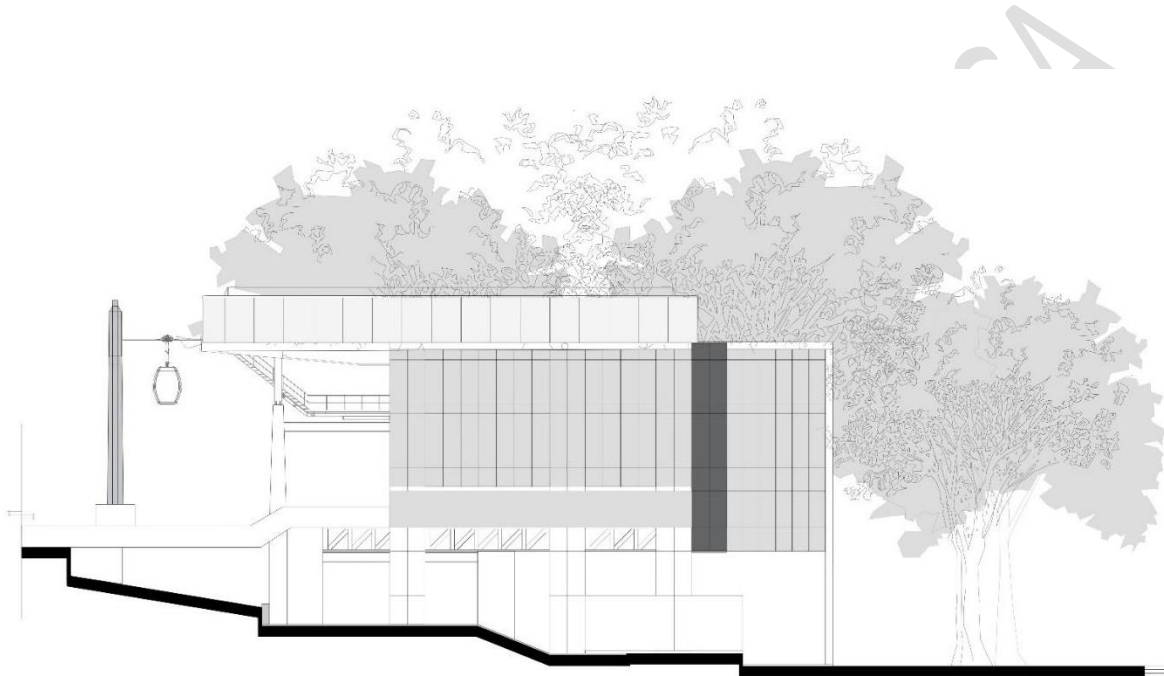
Fachada norte de estación 6 Metro Constituyentes – Los Pinos
